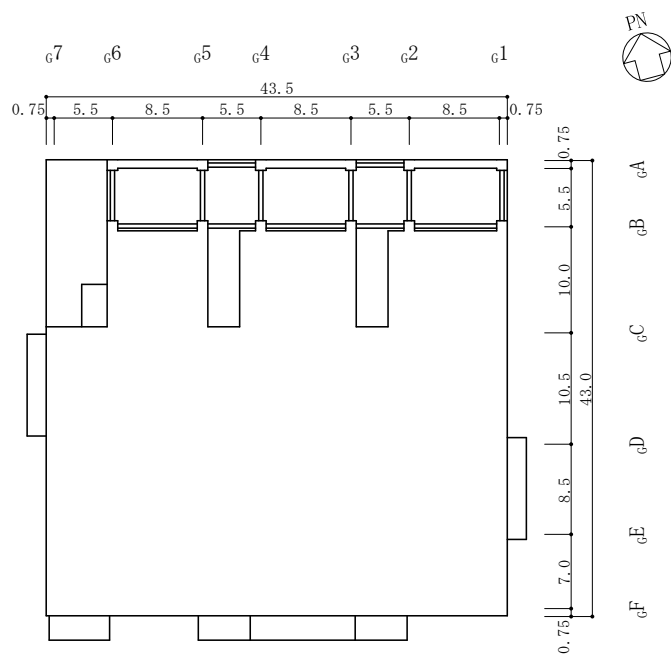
(1) ガスタービン発電機建物の概略平面図 (EL 47.5m*)
